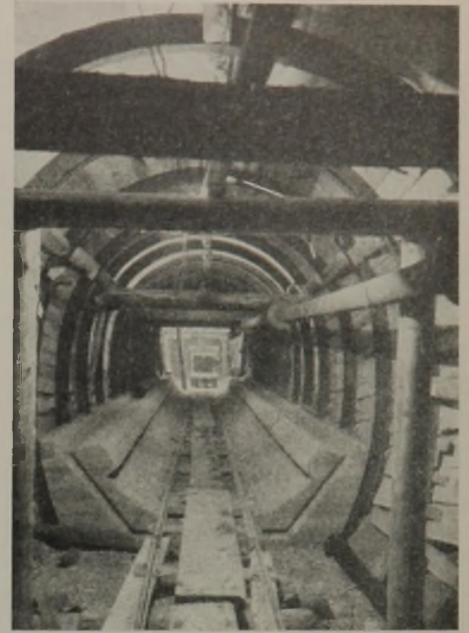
Kanal Eisenheimer Straße: Sohlenbeton mit Aussparung für die Klinkerrollschicht.
